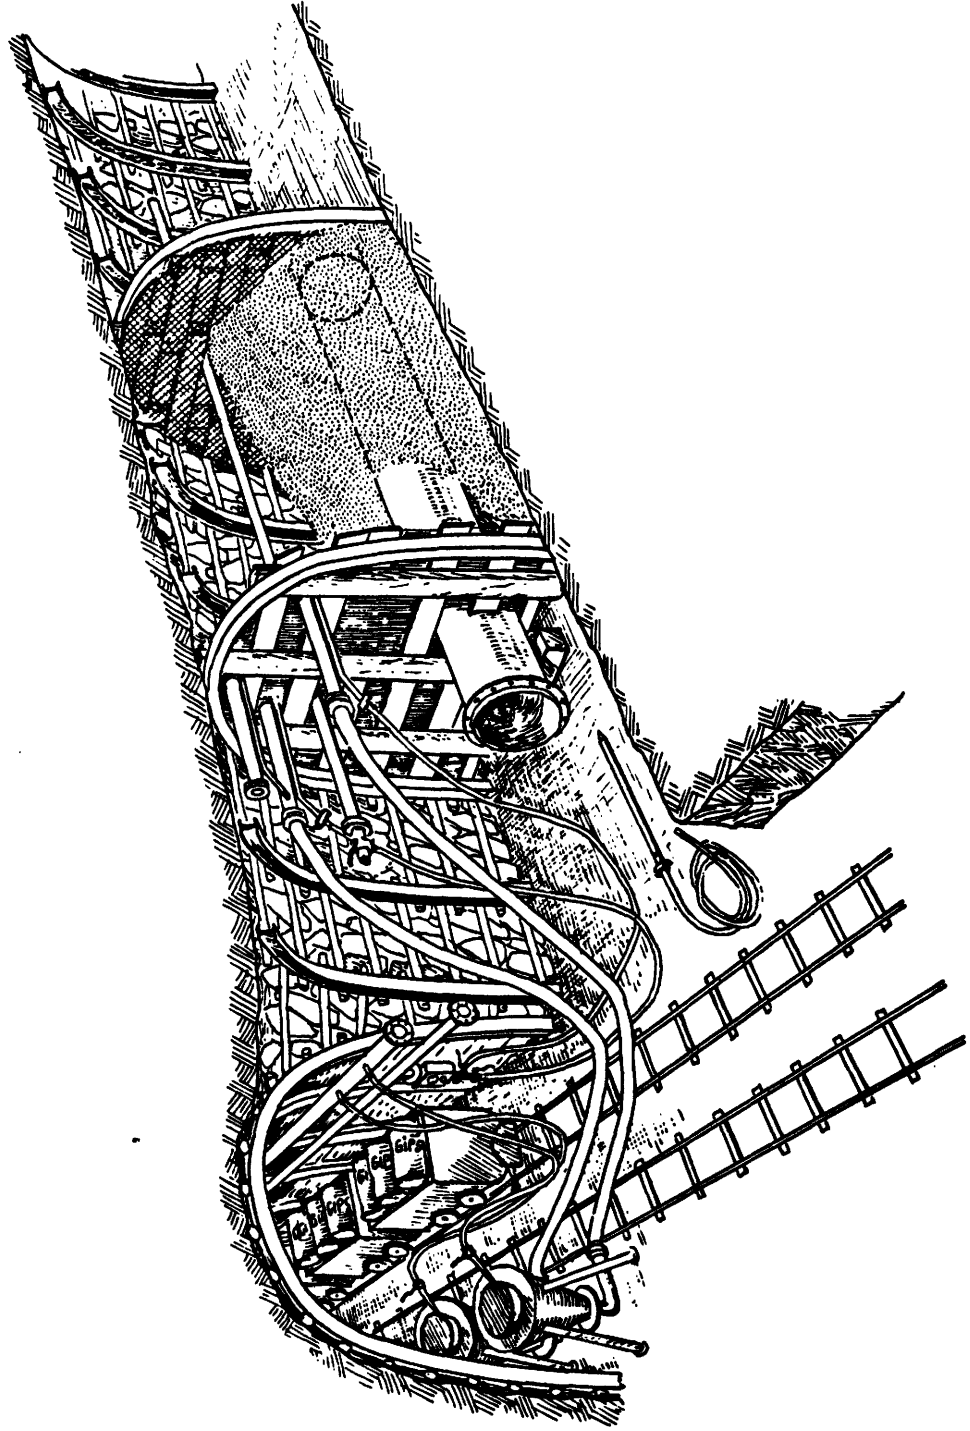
Représentation schématique de la construction d'un barrage en plâtre
